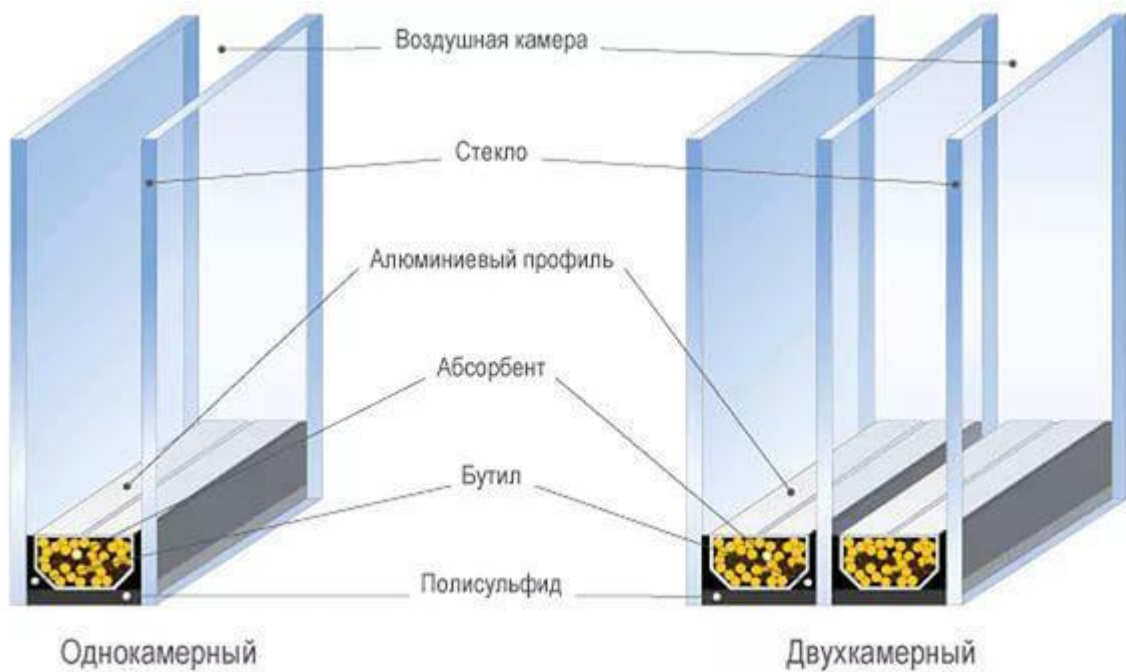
Однокамерный и двухкамерный стеклопакет
